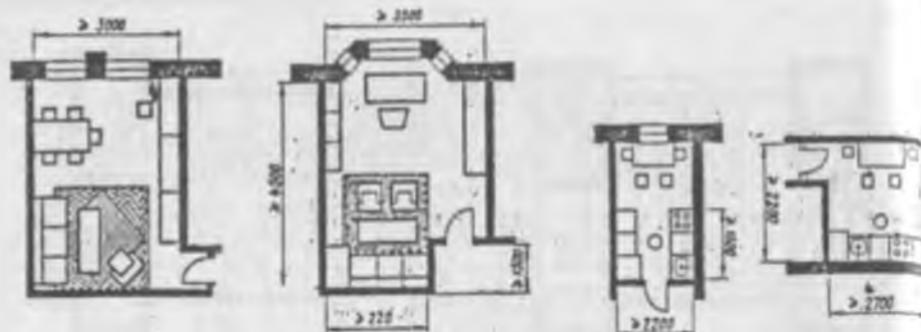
Варианты планировочных решений общих комнат при реконструкции жилых зданий [25]
